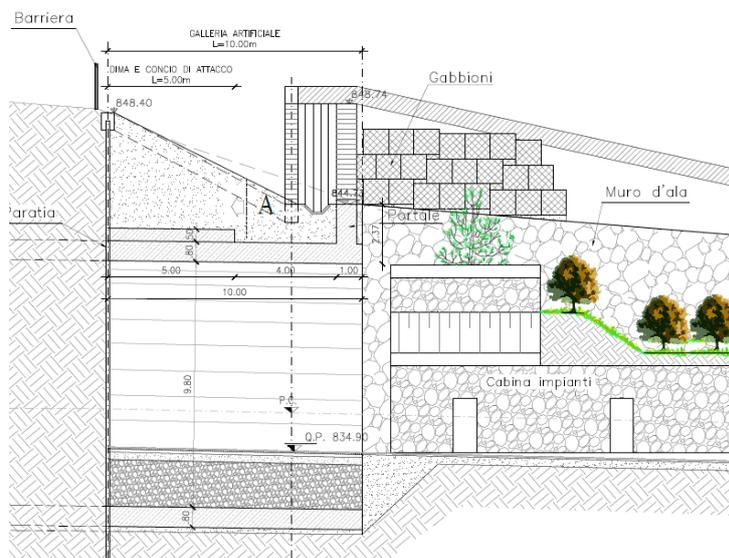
Muro di controripa zona svincolo Est: prospetto lato monte e cabina impianti antistante
